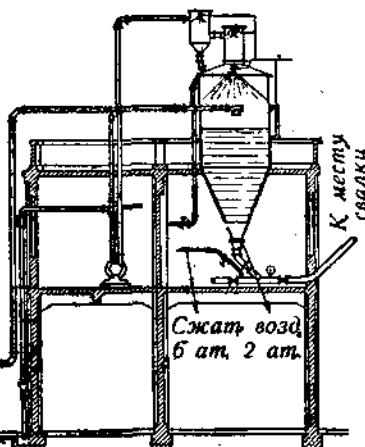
Золоудалляющая установка без скребковой ленты.
